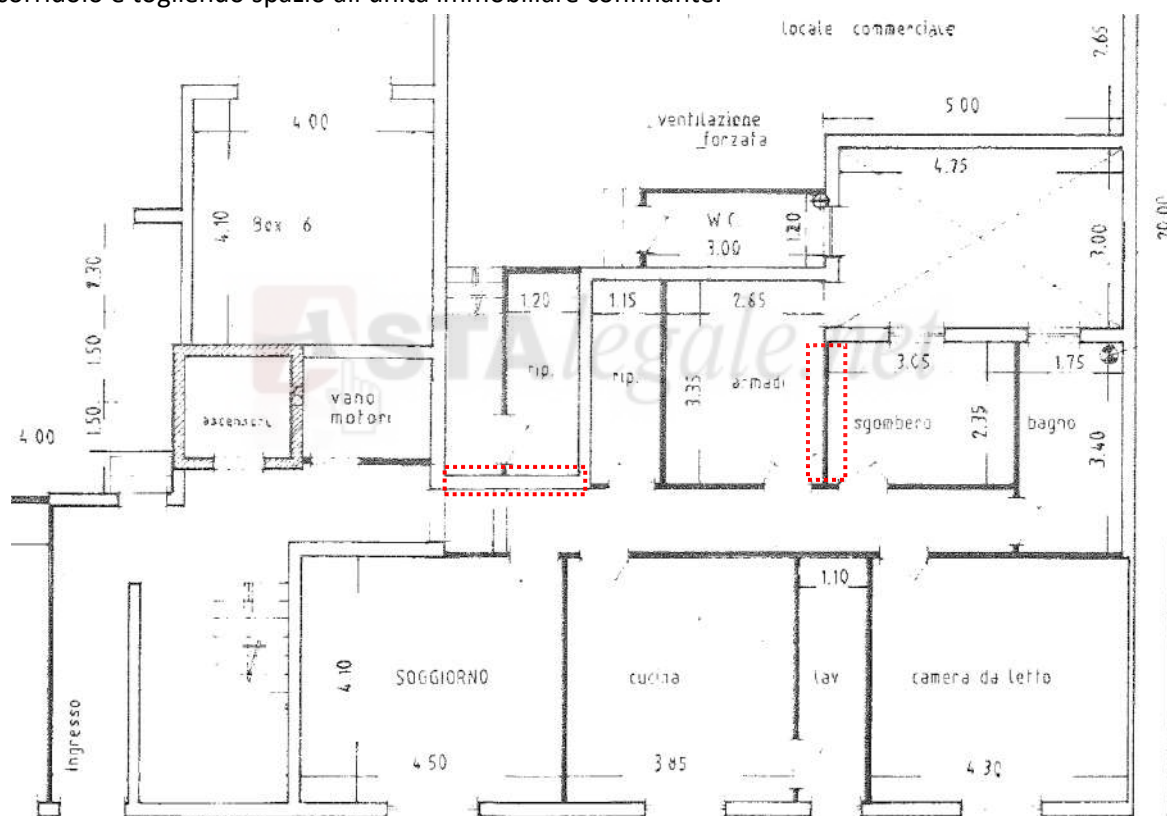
Lotto 1: Planimetria del progetto approvato, con indicata la difformità rilevata
